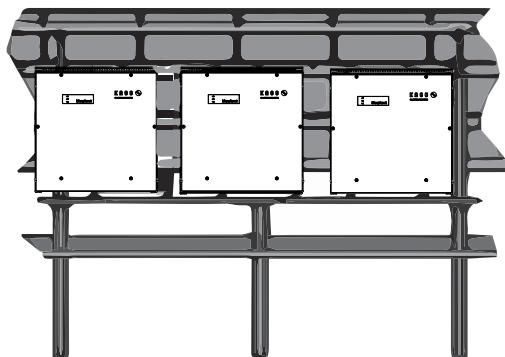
Montagem sobre superfície livre por baixo da instalação FV
